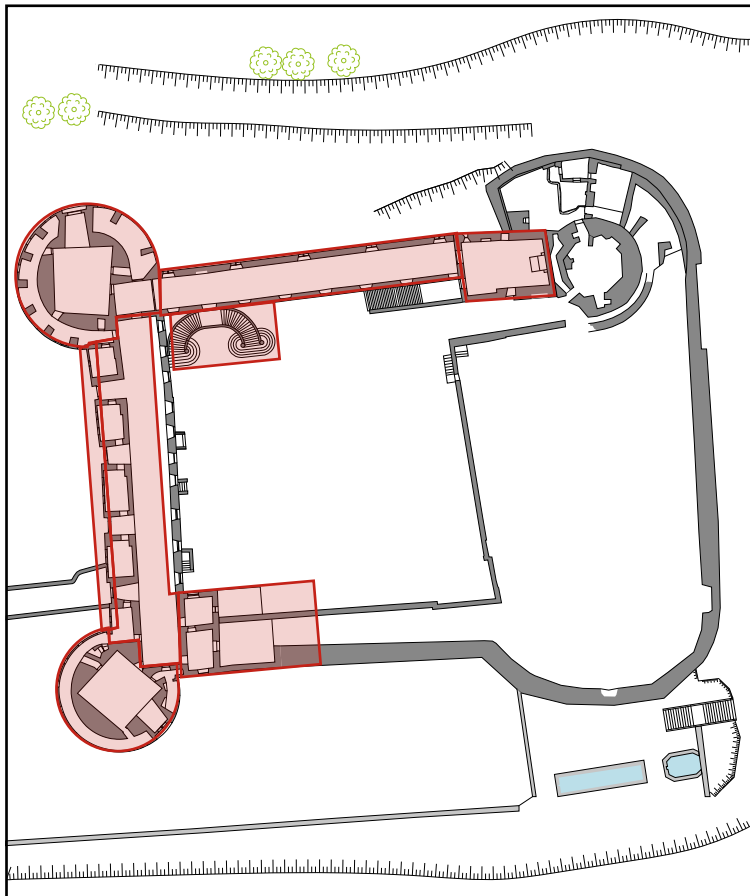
A - Les campagnes de restauration du château de Pontivy
